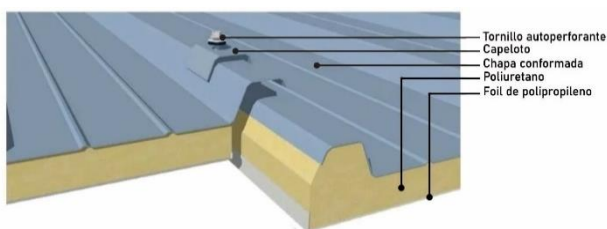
Detalle panel Foilroof – Detalle de Solape.
